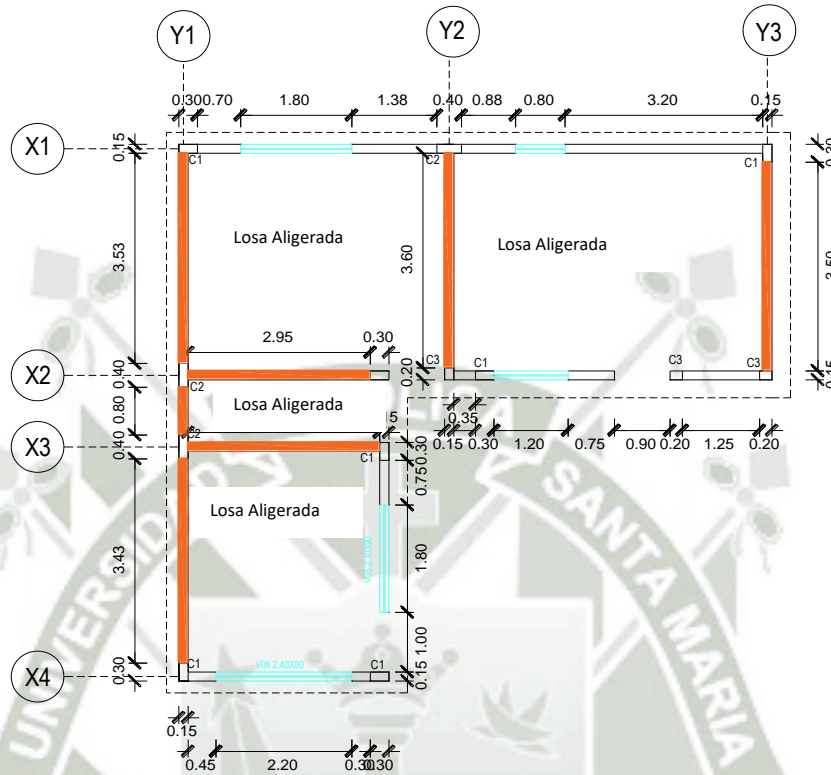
Vista de Planta Irregular en Vivienda CH-04
